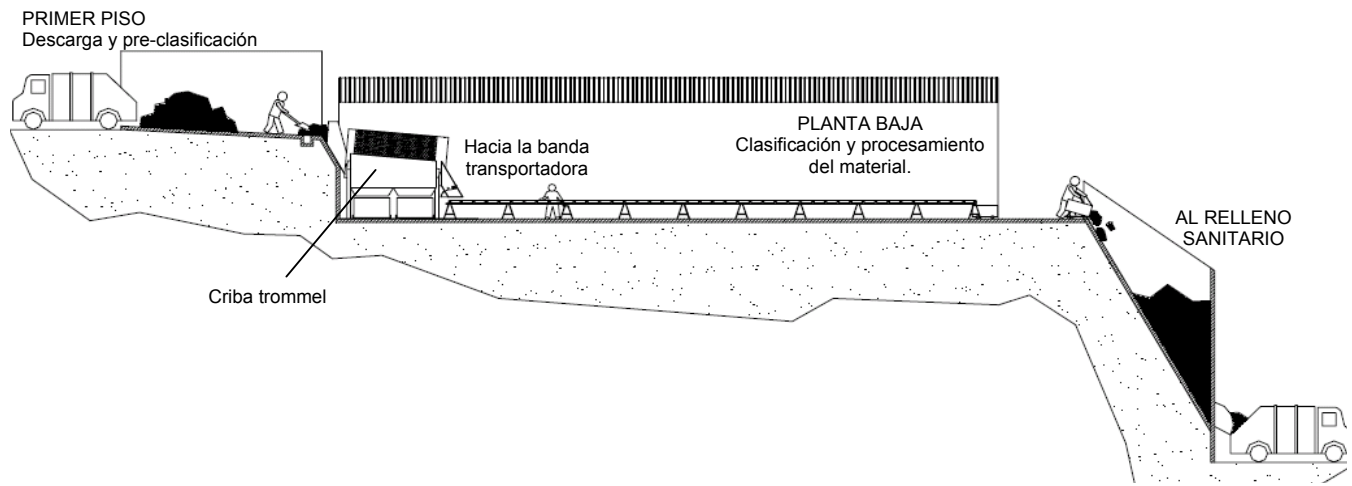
Planta de reciclaje (instalación aprovechando la pendiente natural del terreno)
